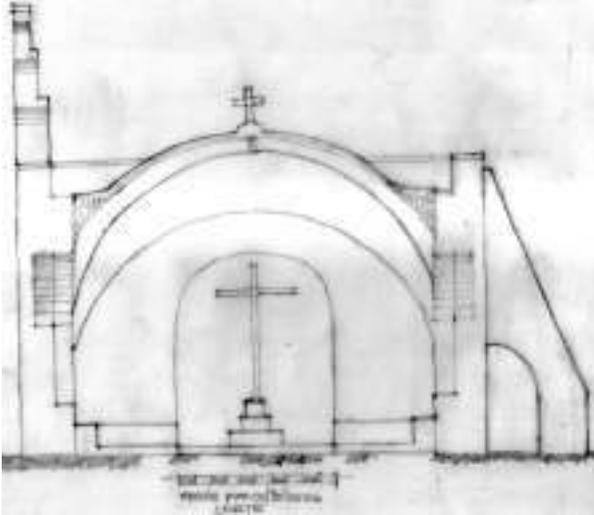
Corte "cámara de los secretos", patrón 10 pies.
